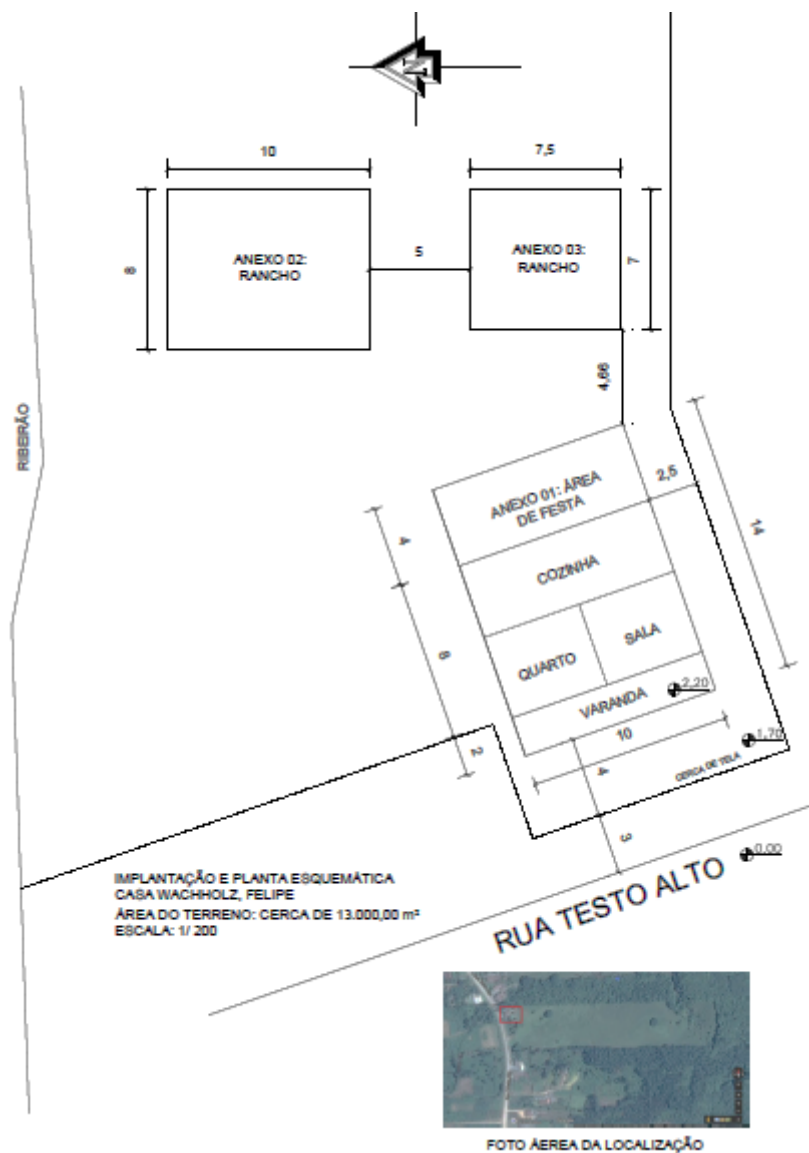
Implantação e planta esquemática – Casa Wachholz, Felipe. Pomerode, 2016.
